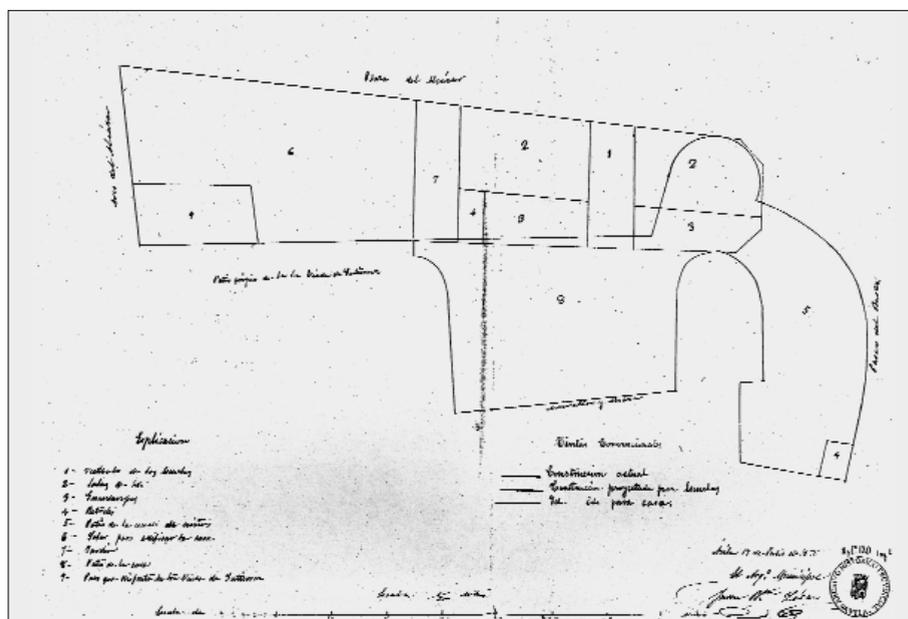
J. B. Lázaro. Zona exterior del alcázar en 1879.
